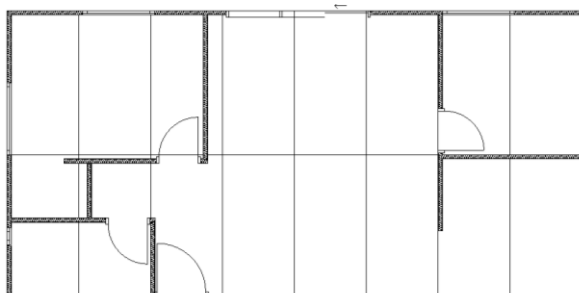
Planta casa básica. Fuente: Elaboración propia.
